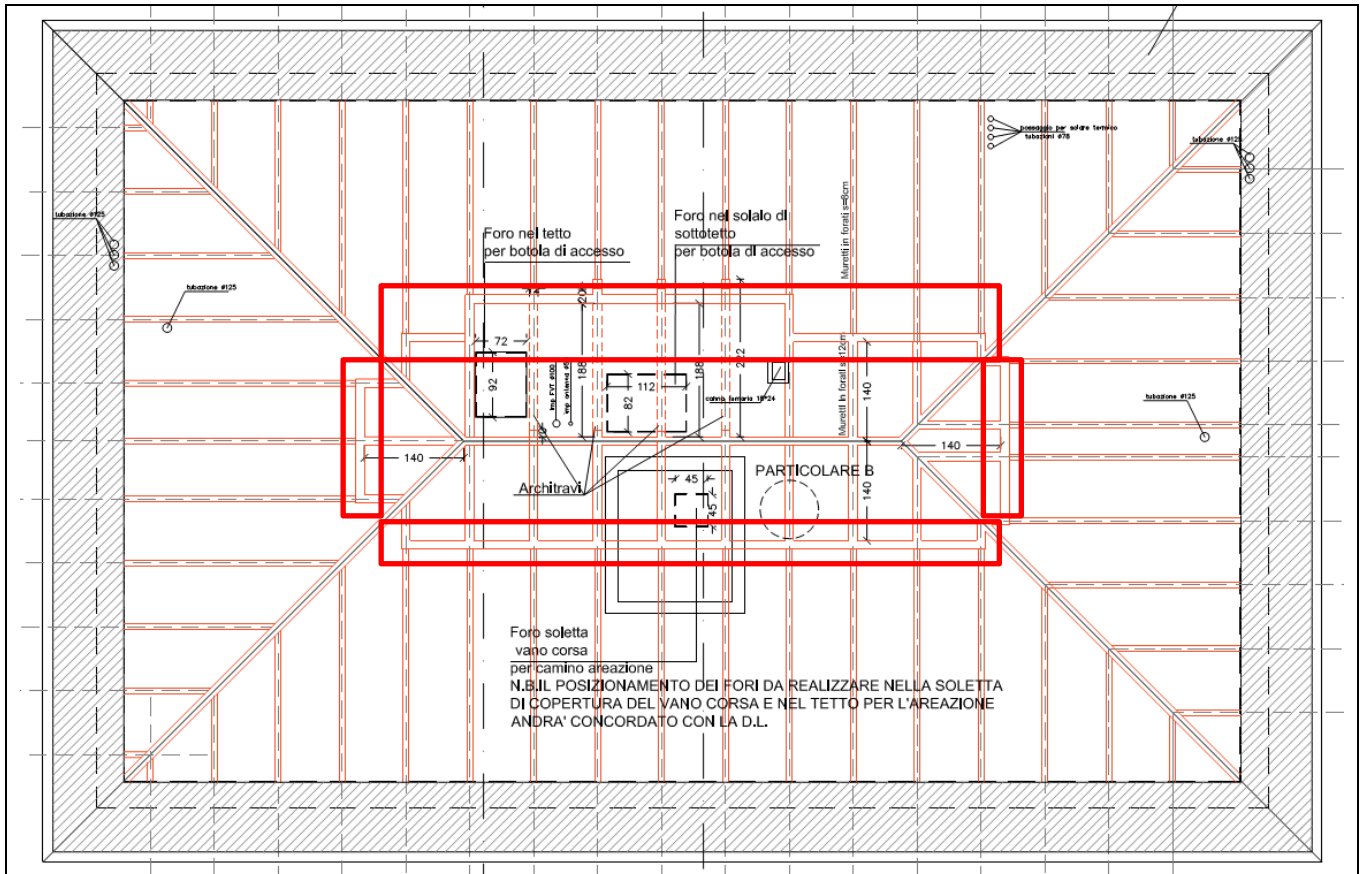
PIANTA DISPOSIZIONE MURETTI
